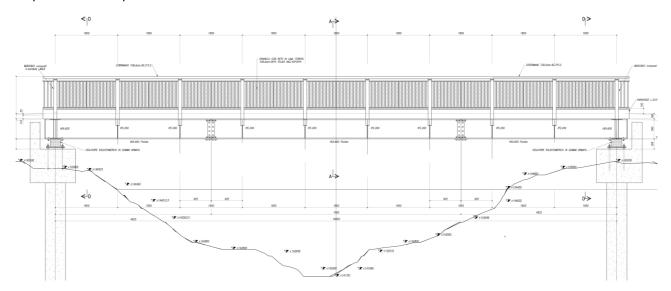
Vista in prospetto della passerella sul Rio Maggiore
